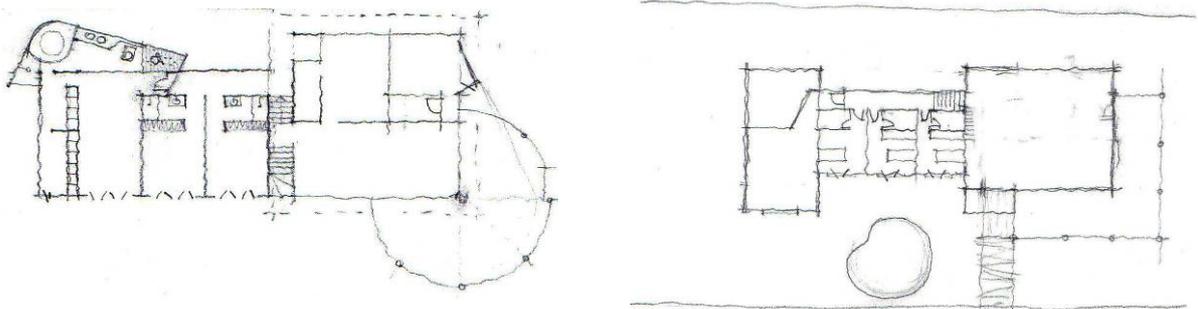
Rascunhos de variações da planta baixa do pavimento térreo
